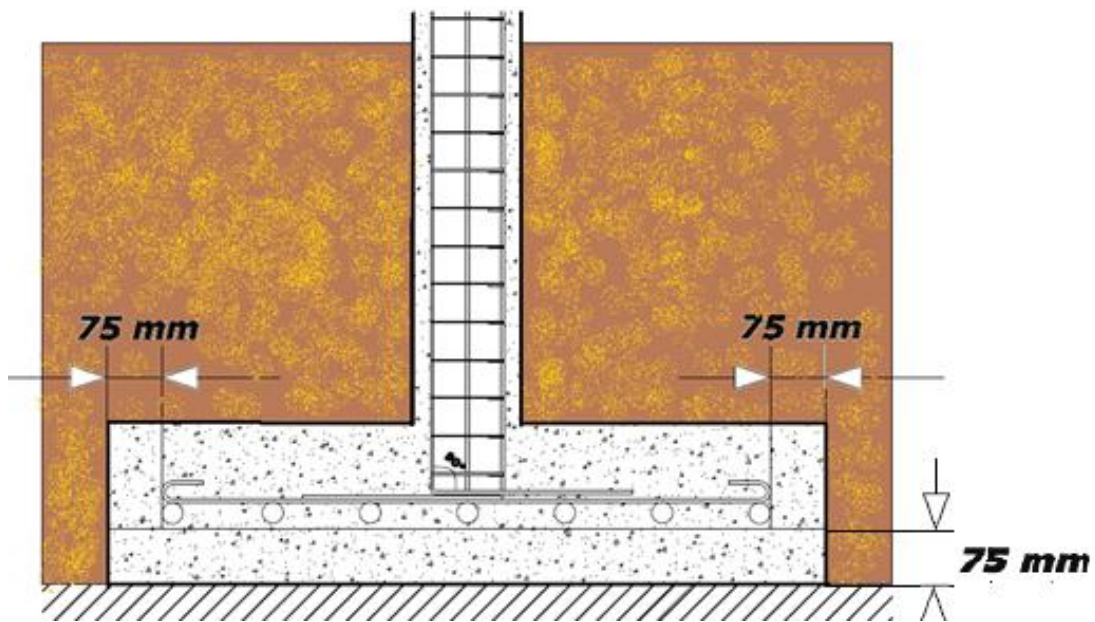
Protección del concreto para el refuerzo colocado contra el suelo y expuesto permanentemente a él
